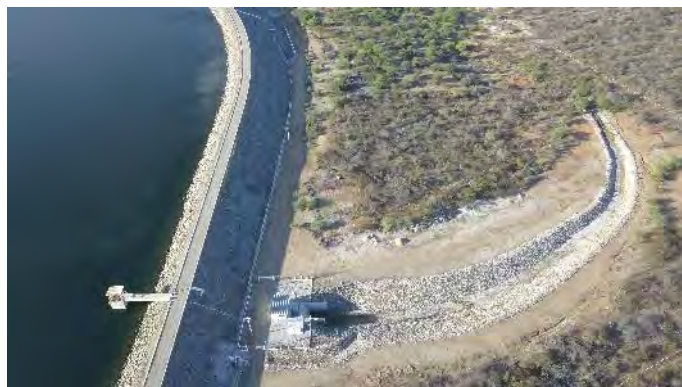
Barragem Tucutu - Canal de Restituição da TUD
